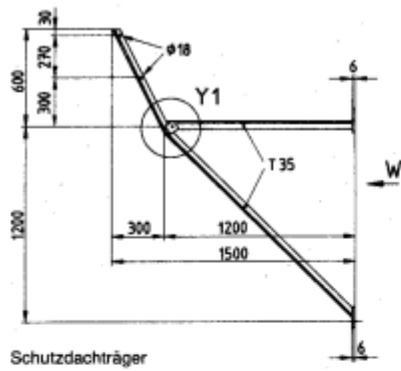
Formen, Maße und Ausführungen von Leitergerüstbauteilen aus Holz (Maße in mm)
